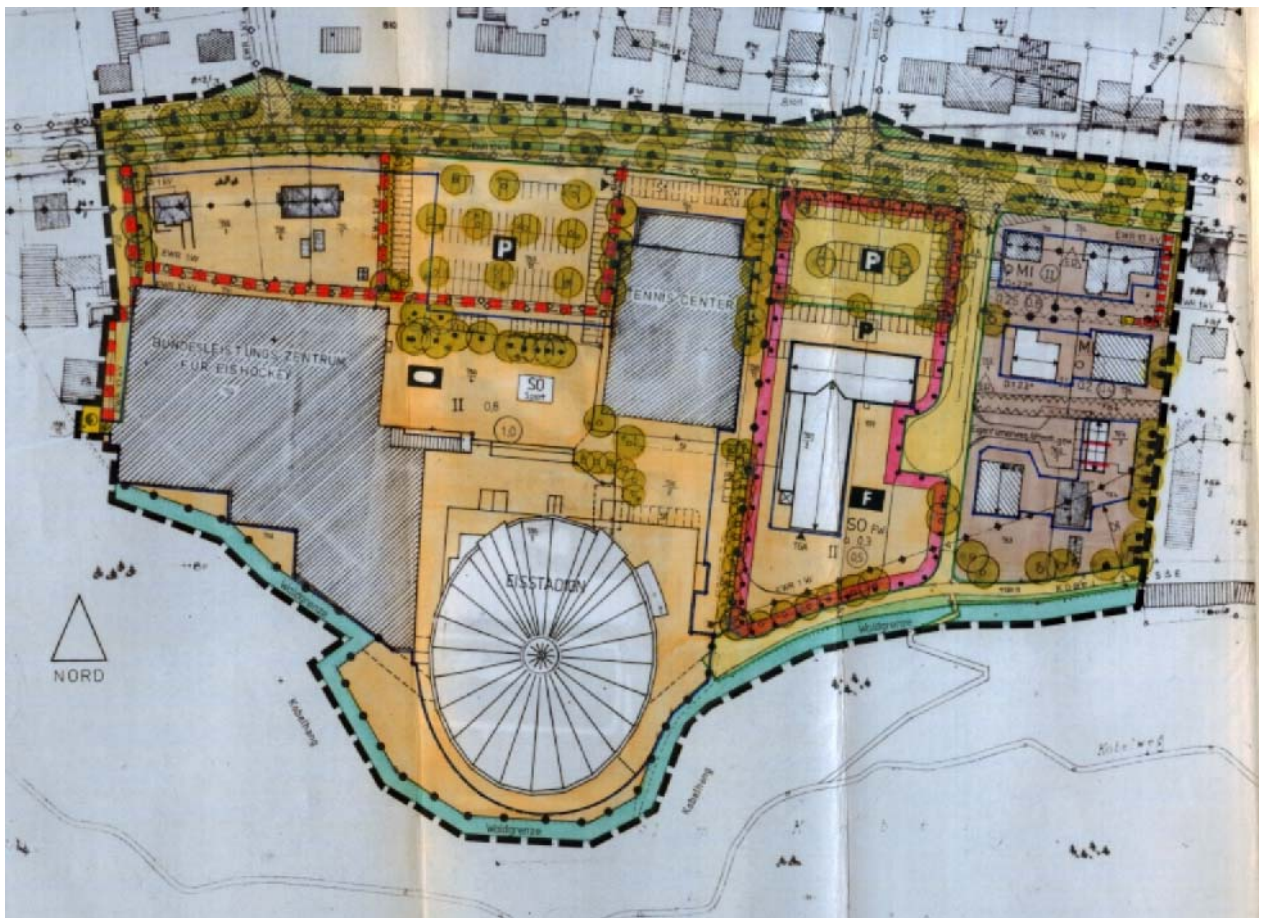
Bebauungsplan W 27 - Am Kobelhang
